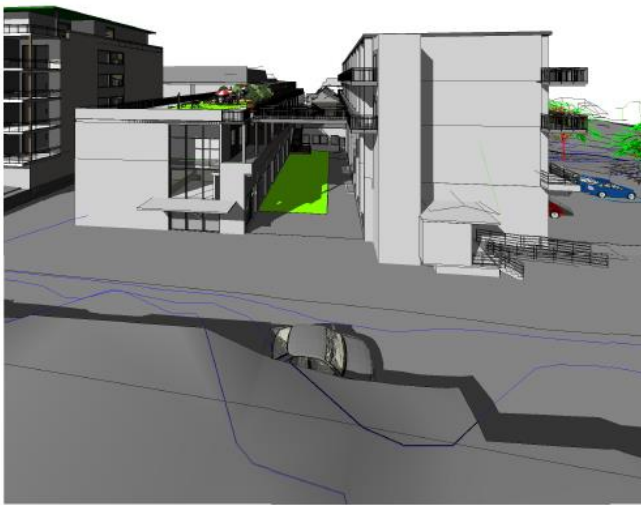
Illustrasjonsplan (Einar Lundstad)
